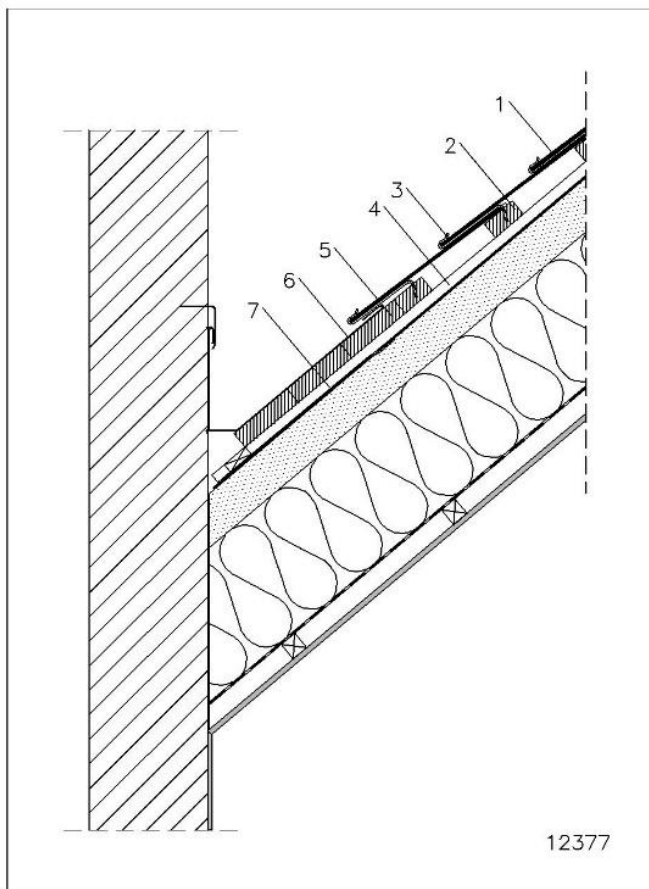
Schouwafwerking of schoorsteenaanbouw bovenkant
